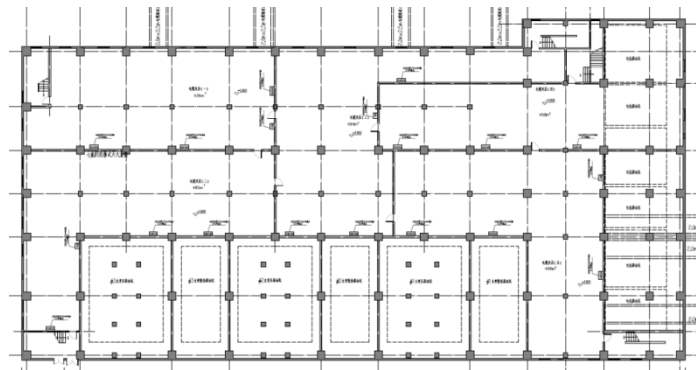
TJ-220-A2-4 方案电缆夹层七氟丙烷气体灭火系统平面布置图
